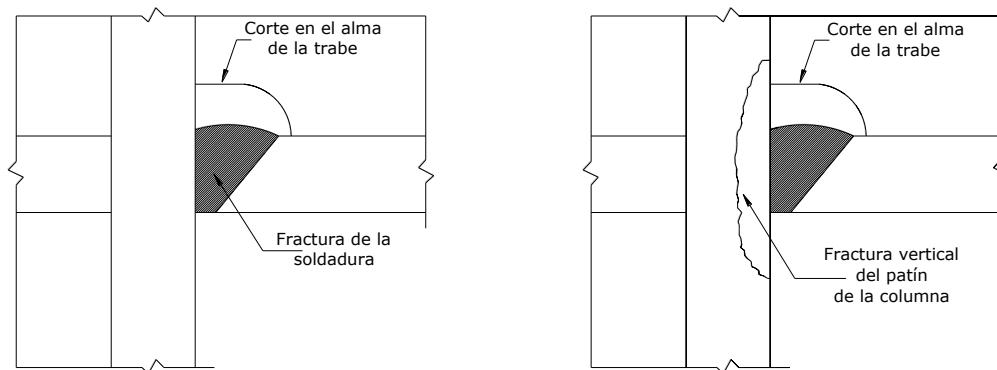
Falla de conexión soldada debido a sismos de gran intensidad.
